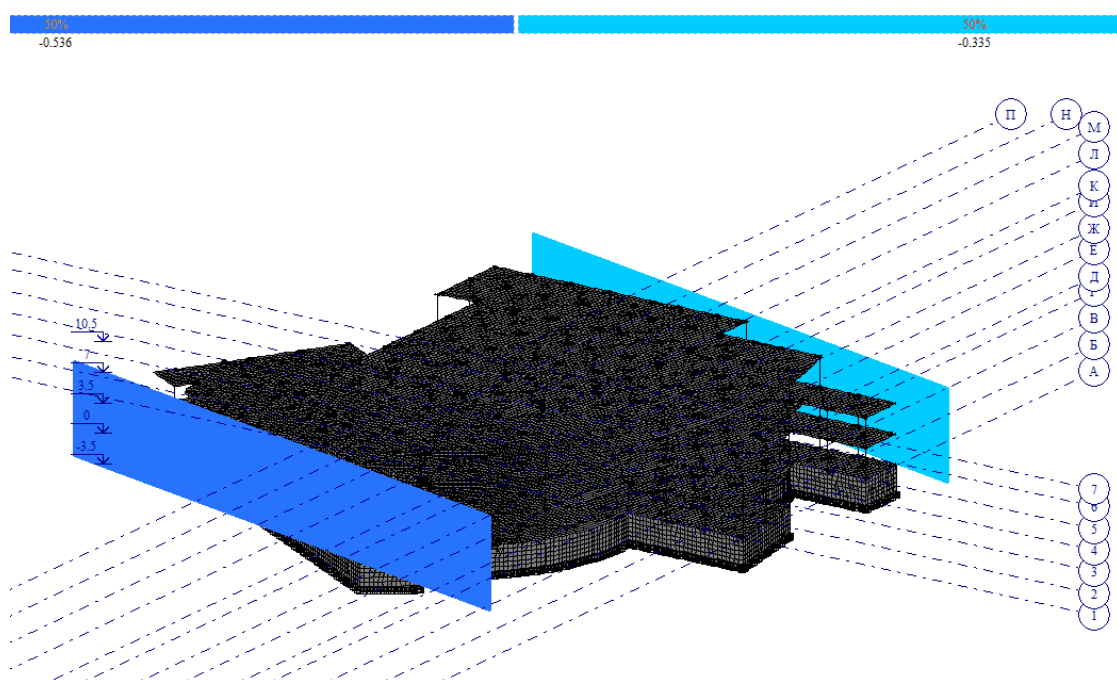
Ветровые нагрузки по оси X на торцевые стены
